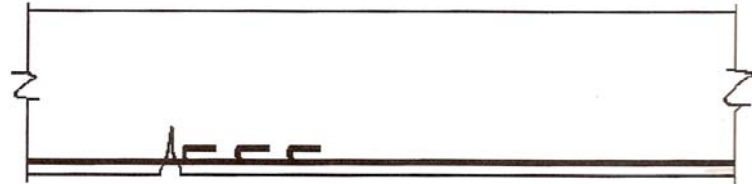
Fissuras devido a forte concentração de ganchos na mesma seção. (Souza, 1999).
